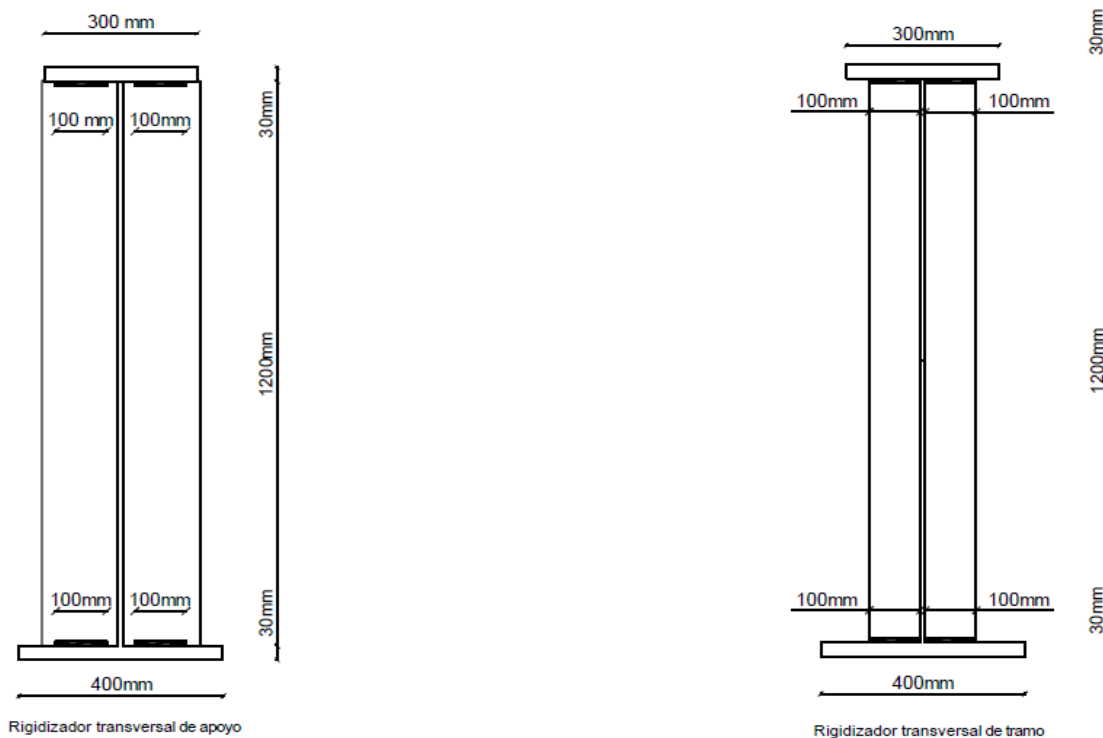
Vista frontal de la soldadura tipo filete. Elaborado por: Autor
